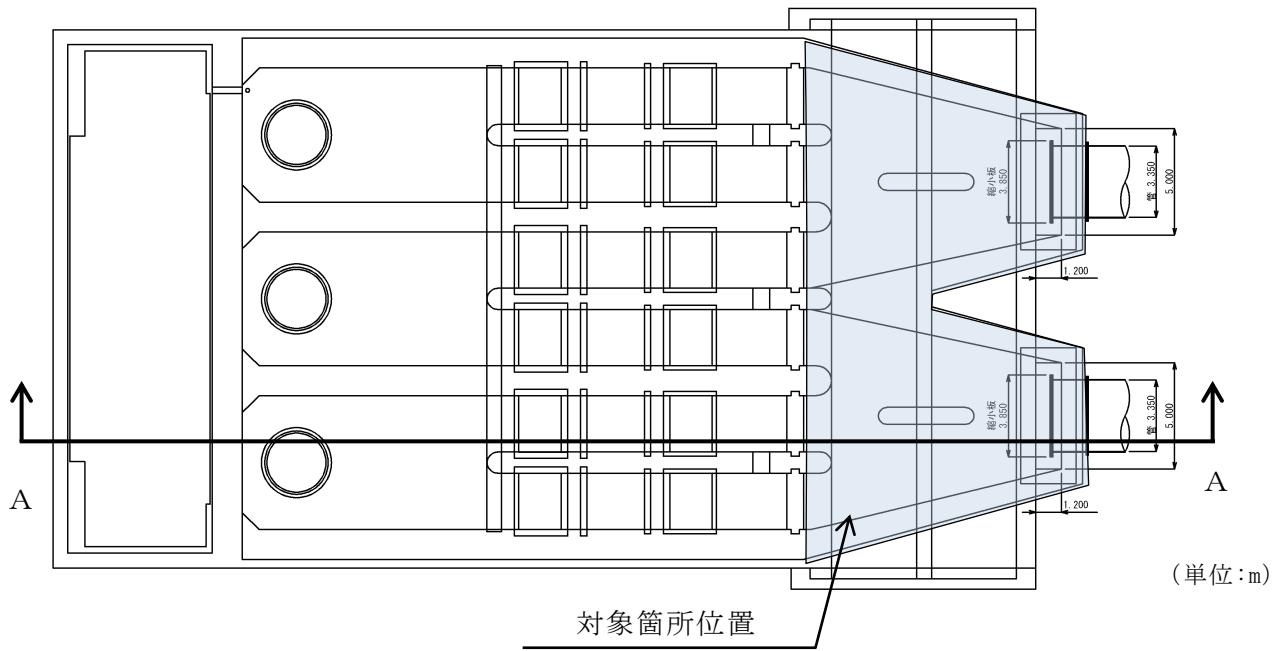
1号機取水槽ピット部及び1号機取水槽漸拡ダクト部底版平面図
